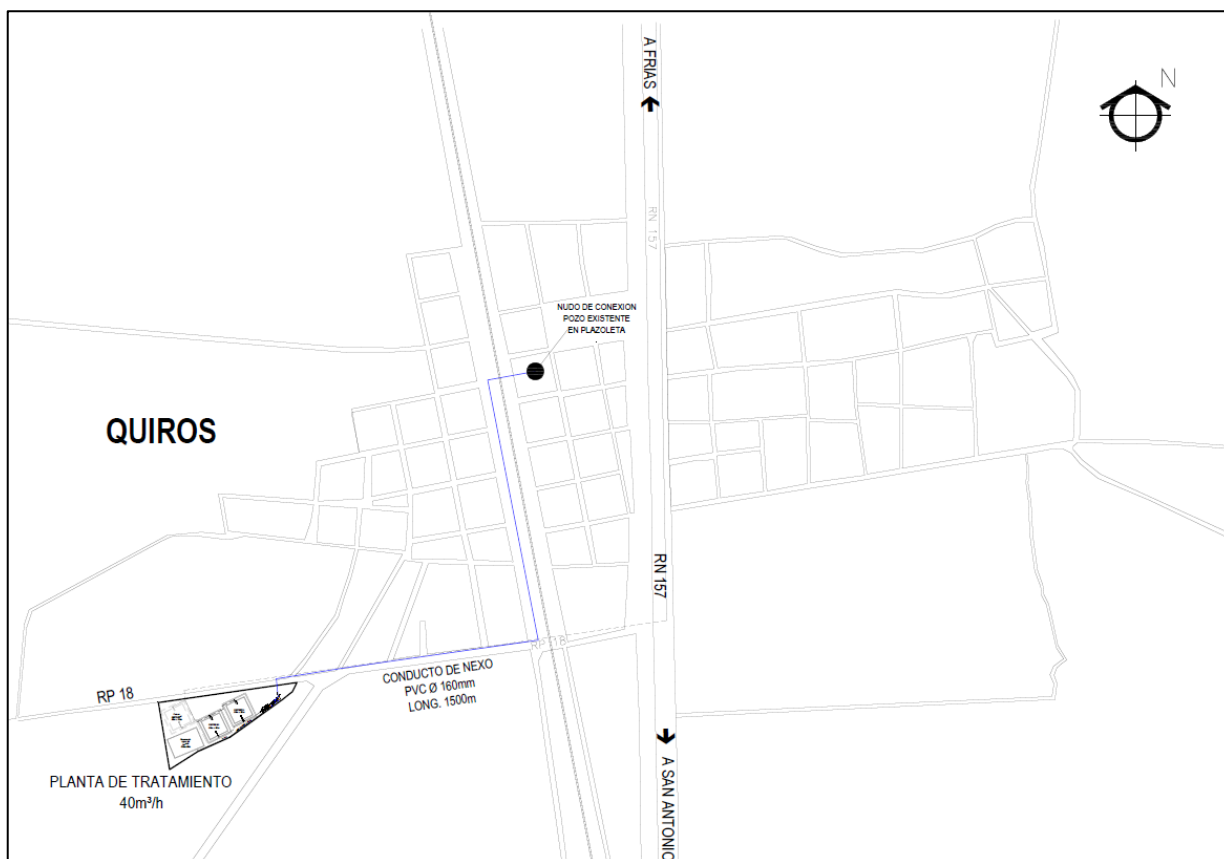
Nexo de Planta de Tratamiento con la red existente en Quirós
